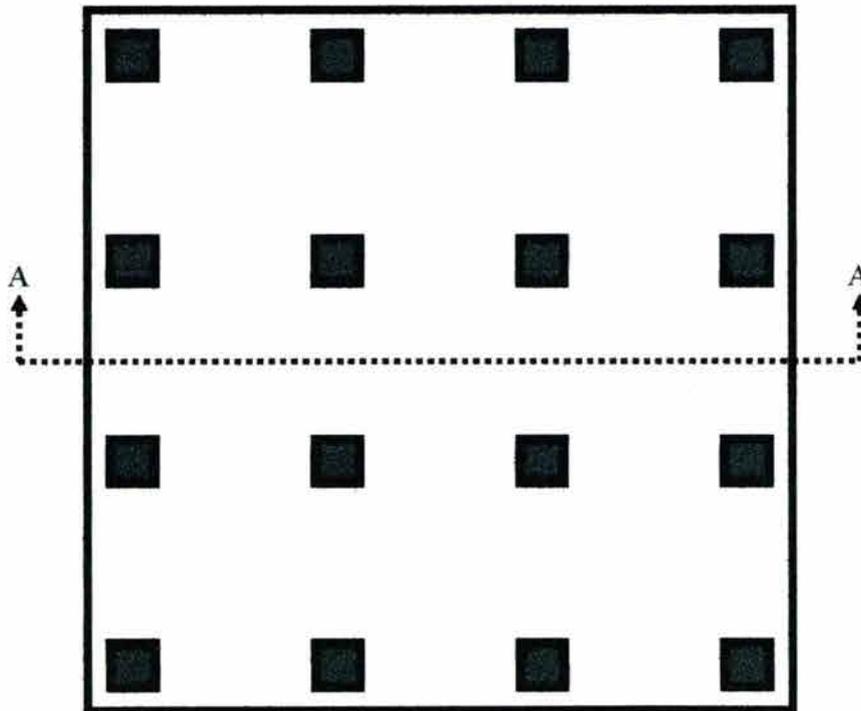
Cimentación con concreto simple y con concreto ciclópeo
